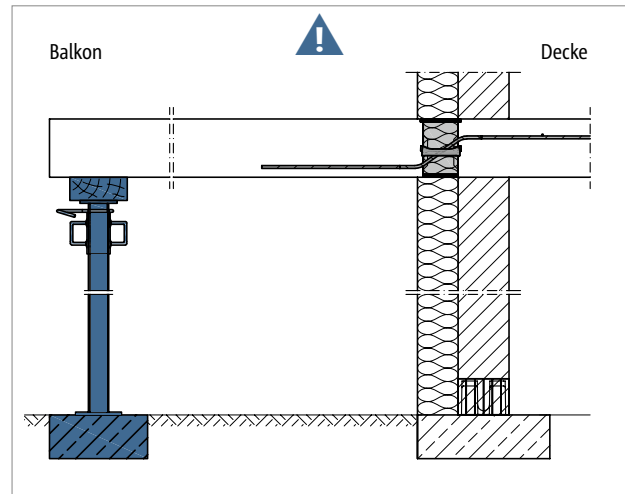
Schöck Isokorb® XT Typ QL: Stützung durchgängig erforderlich
